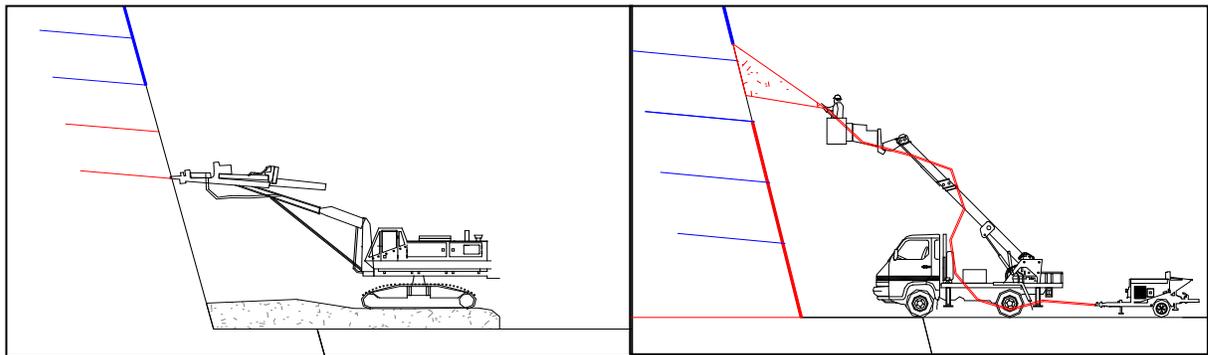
Colocación de Anclajes, Concreto Lanzado y Drenajes
